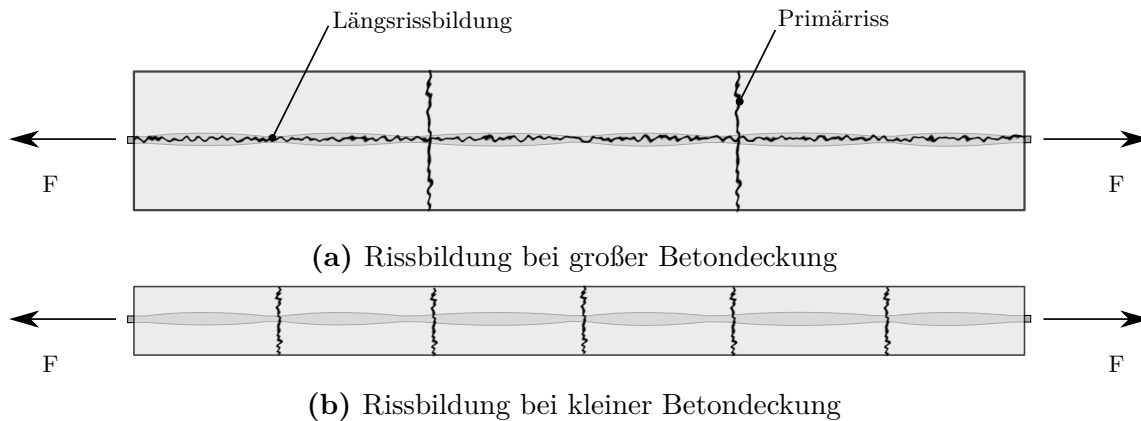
Rissbildung in Abhängigkeit der Betondeckung
